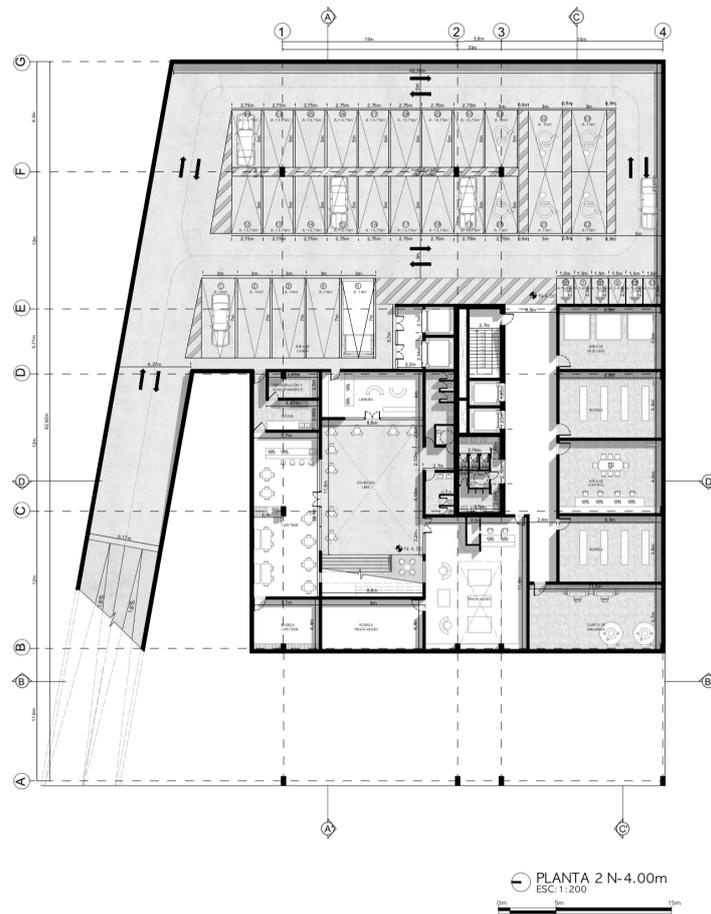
Planta subsuelo N-4.00m. Elaboración propia.
